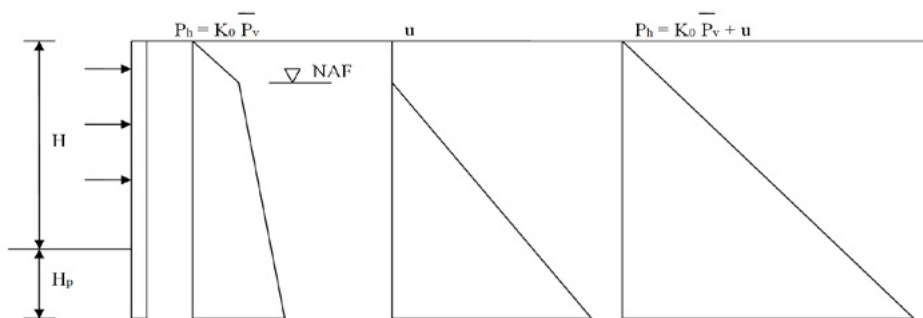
Presiones horizontales sobre el ademe de la excavación ($N_b \leq 4$)
